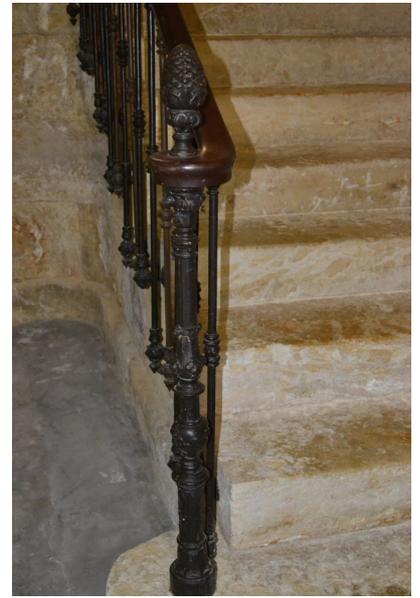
Escalier, rez-de-chaussée, détail de la rambarde.
